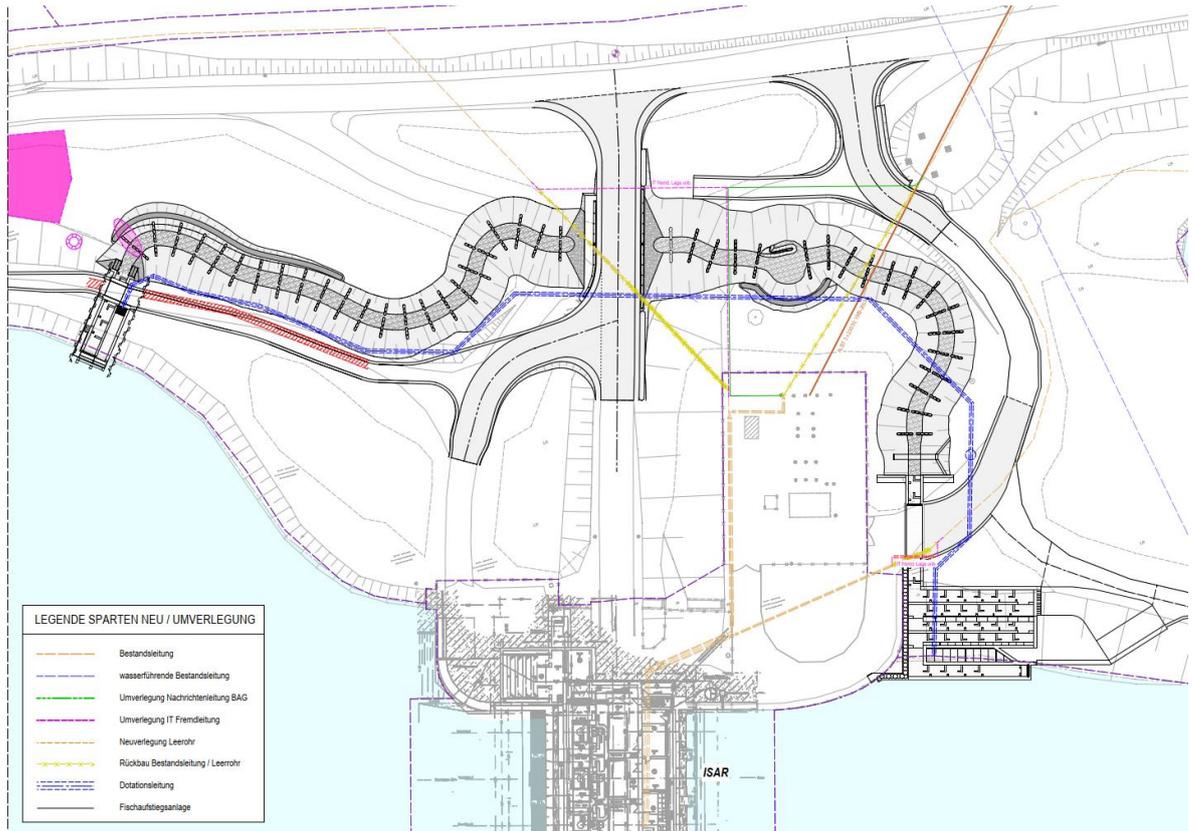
Lageplan betroffener Sparten und deren geplante Verlegung
